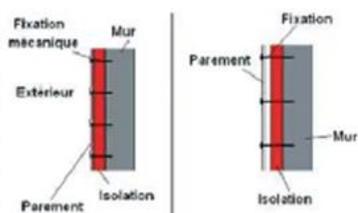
la disposition extérieure d'isolant sur le mur. Source: le guide pour une construction éco énergétique en Algérie.
